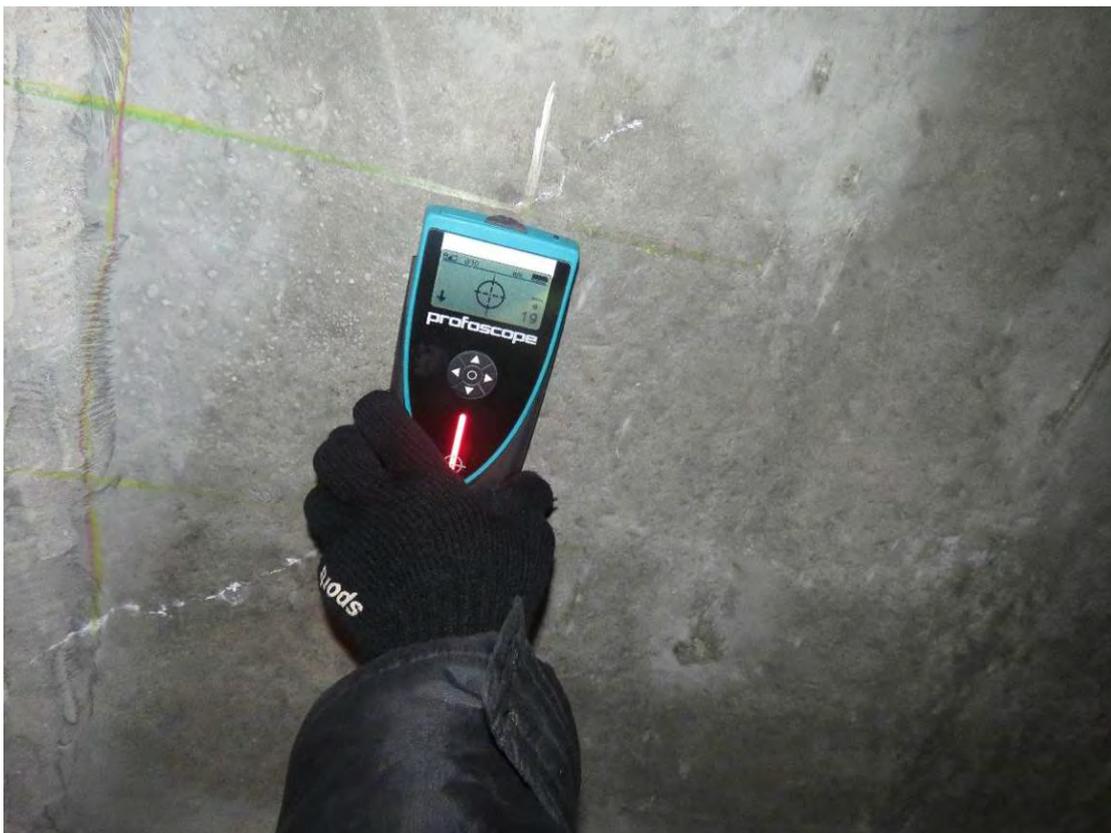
Определение положения рабочей арматуры и толщины защитного слоя бетона в монолитной ж.б. плите перекрытия магнитным методом прибором «Profoscope»
